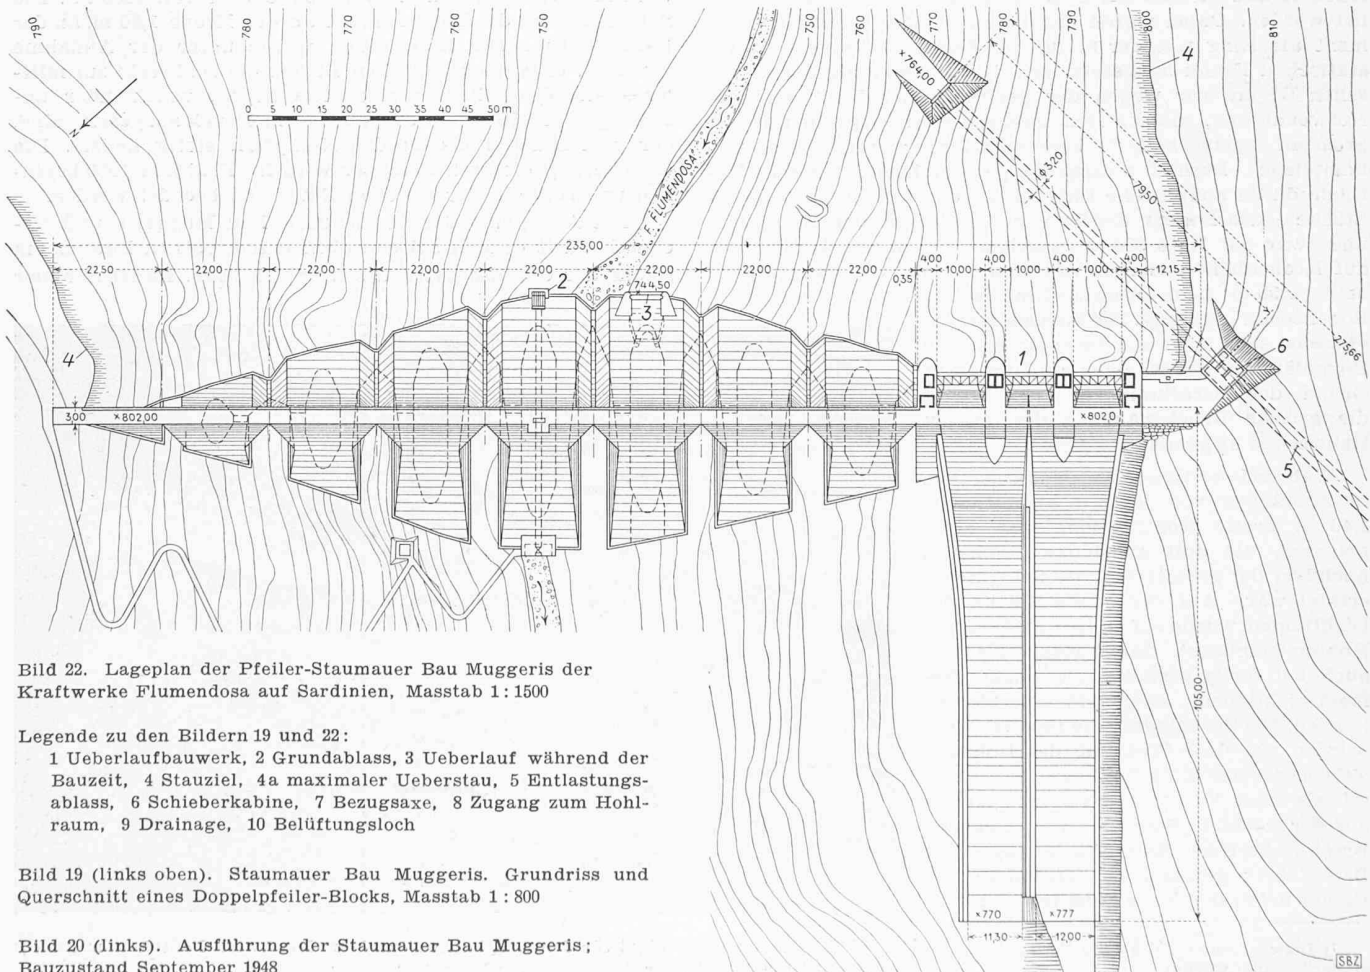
Lageplan der Pfeiler-Staumauer Bau Muggeris der Kraftwerke Flumendosa auf Sardinien, Masstab 1: 1500
